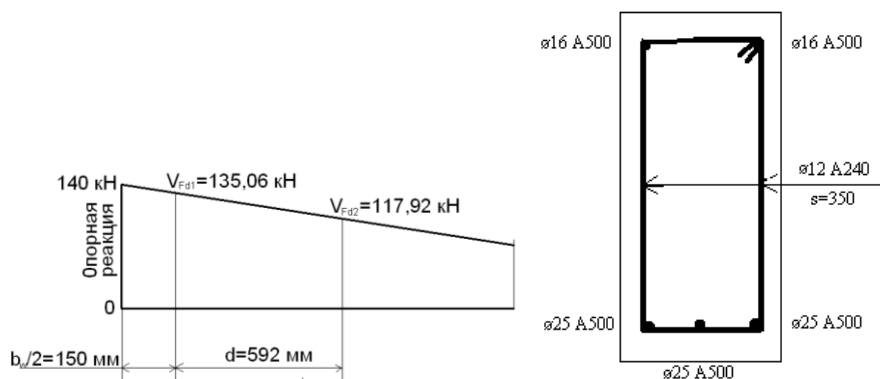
Схема положения расчетного сечения по поперечной силе
